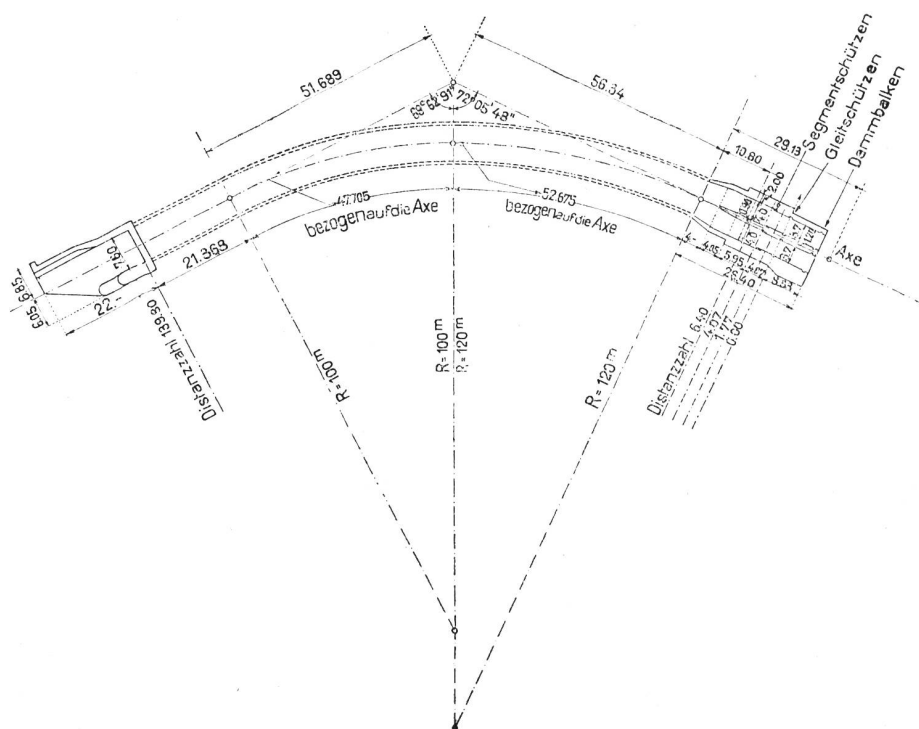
Grundriss des Grundablastollens. Maßstab 1:1500.
